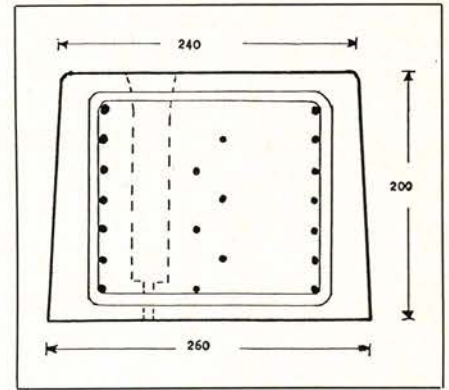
Tverrsnitt av betongsville for sporveksel. Spennarmering er 1/4" ståltau med 7 tråder pr. tau. 2 stk. bøyler pr. sville rundt armeringen er 5 mm Ps 50.
